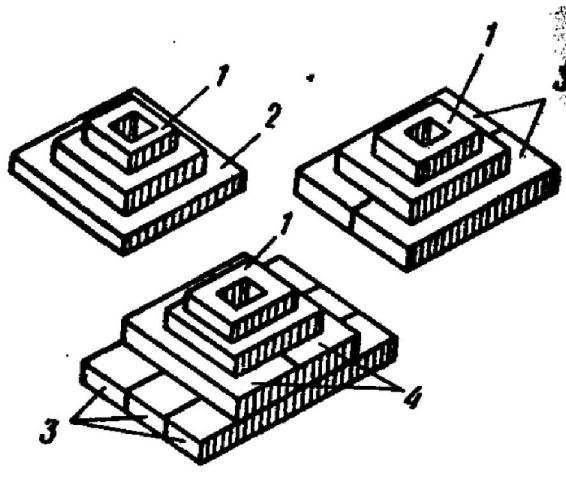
Составные железобетонные фундаменты (1- подколонник; 2- фундаментная плита цельная; 3- то же, блочная; 4- подколонные блоки) [1]
